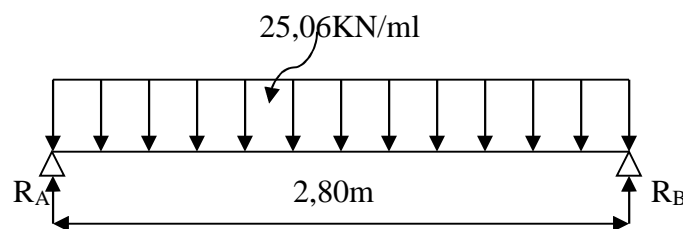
Schéma statique de la poutre palière à l' ELS.
